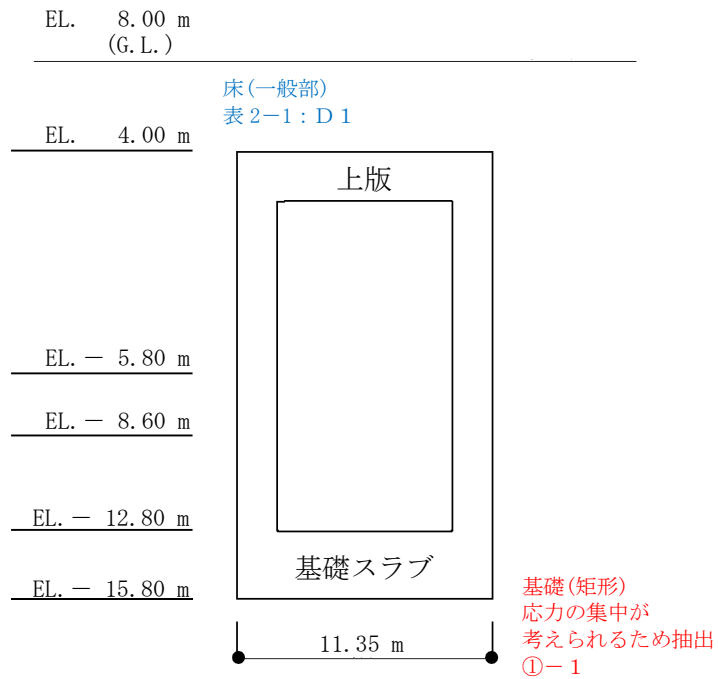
格納容器圧力逃がし装置格納槽の概略断面図 (EW 方向, B-B 断面)
